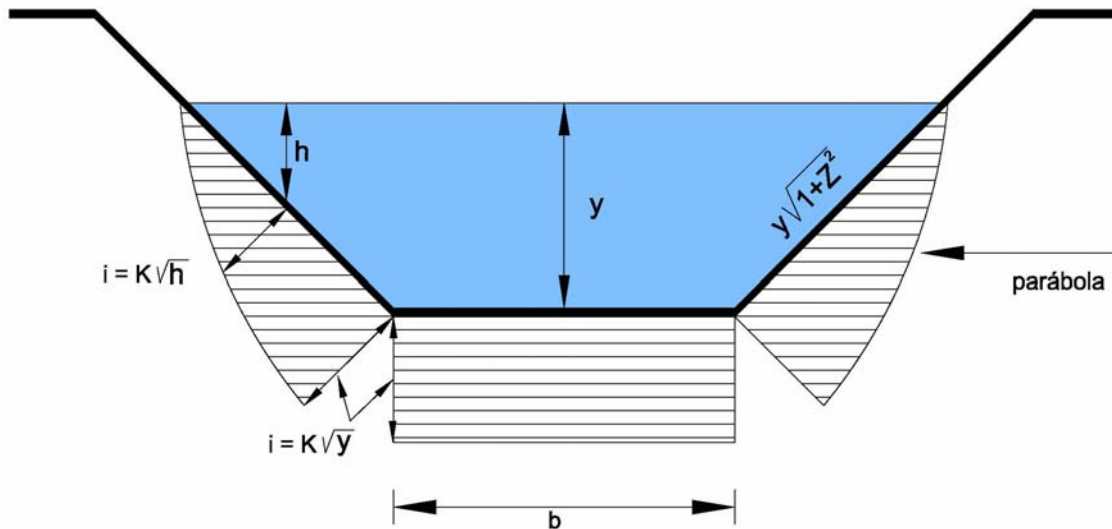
Diagrama de infiltración en las paredes y fondo del canal.
